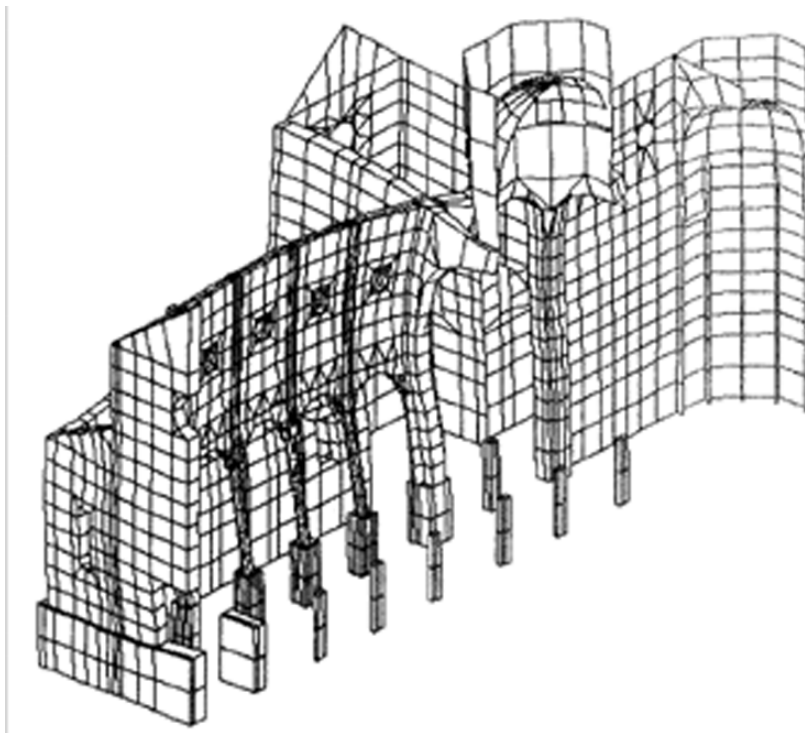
Esempio di modellazione spaziale con elementi finiti piastra e "brick" (14).
